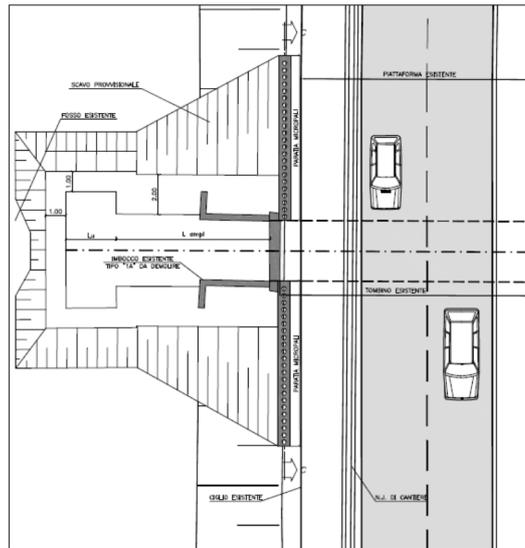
È Pianta opera tipo da prolungare È ante opera
